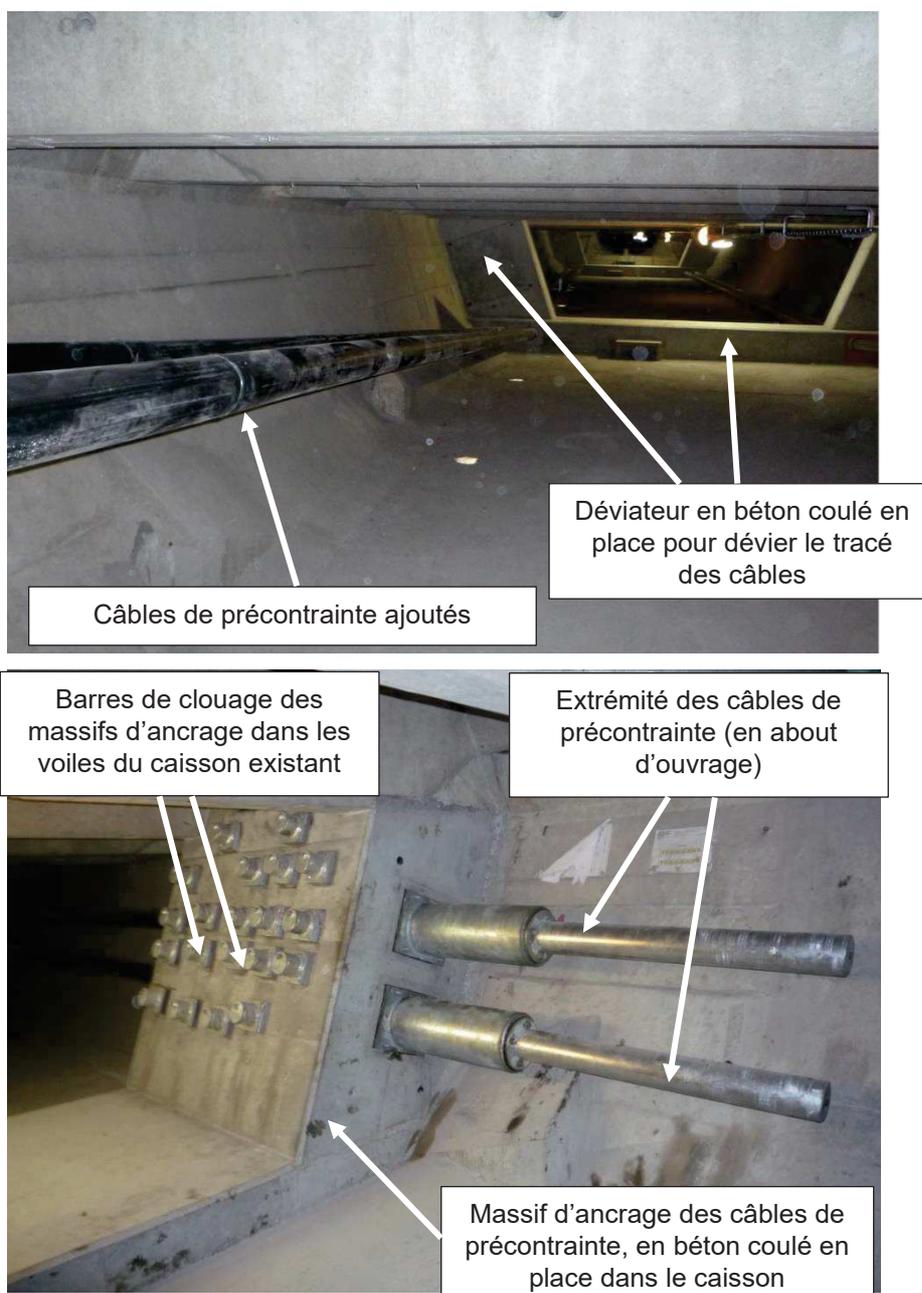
Détails des éléments de renforcement des caissons dans un ouvrage similaire au PI318 (source : Arcadis MOE PRO)
